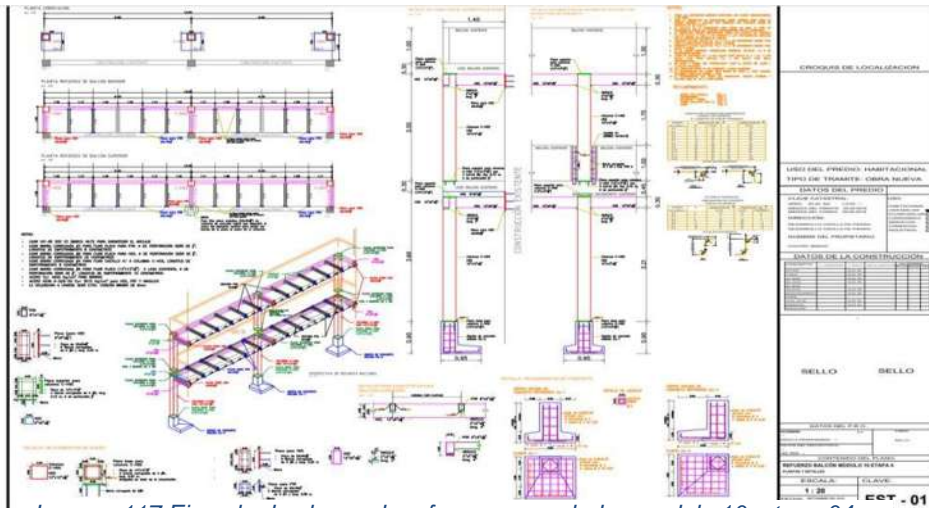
Ejemplo de planos de refuerzos en volados modulo 10, etapa 04 en el desarrollo Capilla de Piedra. Nota: Se realizaron los planos estructuras para reforzar los volados que tuvieron fallas en su armado.
